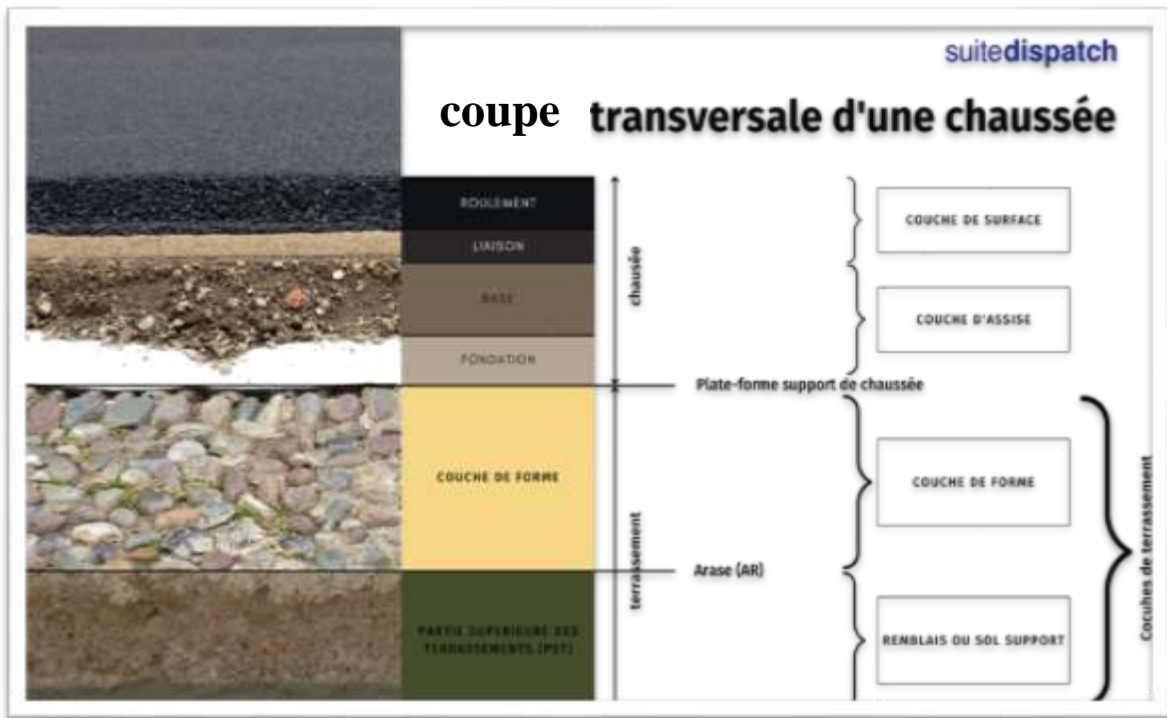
Coupe type d'une structure de chaussée (L. Ordener .2023)
